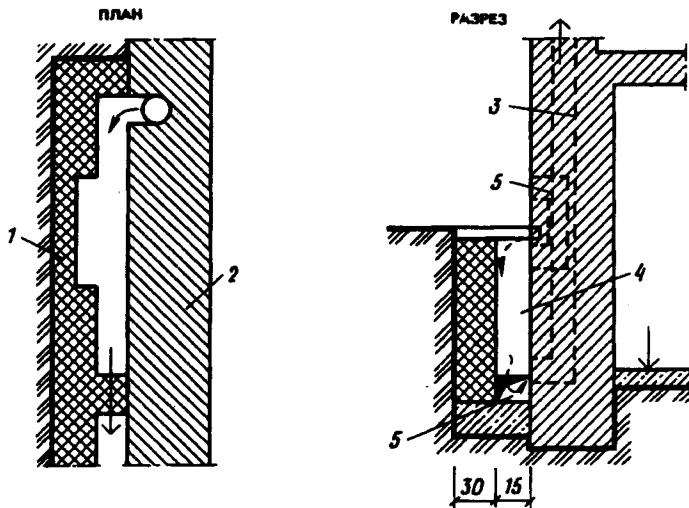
Осушение подземной части стены путем устройства вентилируемой воздушной полости
